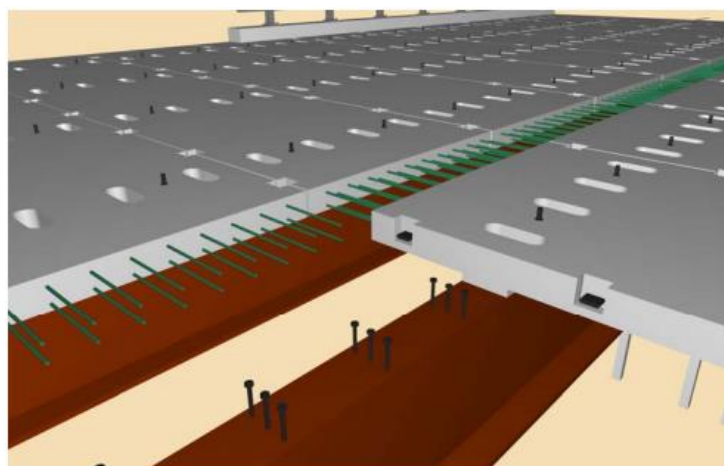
Exemple de dalles préfabriquées en attente de la coulée des joints selon le FHWA
